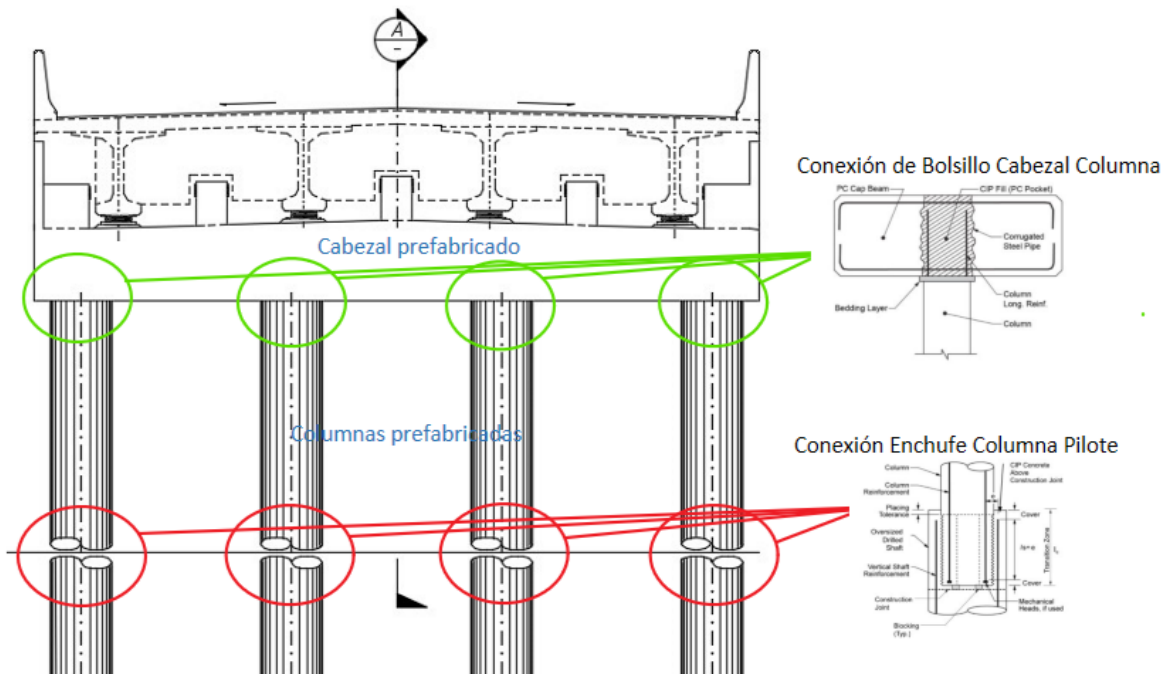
Elementos y conexiones a diseñar cepa. Fuente: Planos de Proyecto modificados.
